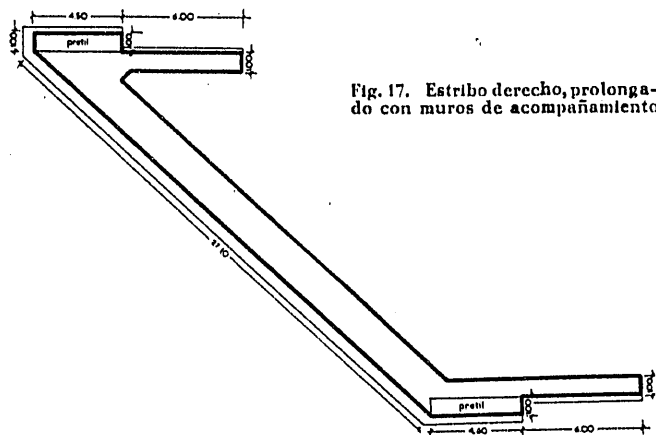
Estribo derecho, prolongado con muros de acompañamiento
